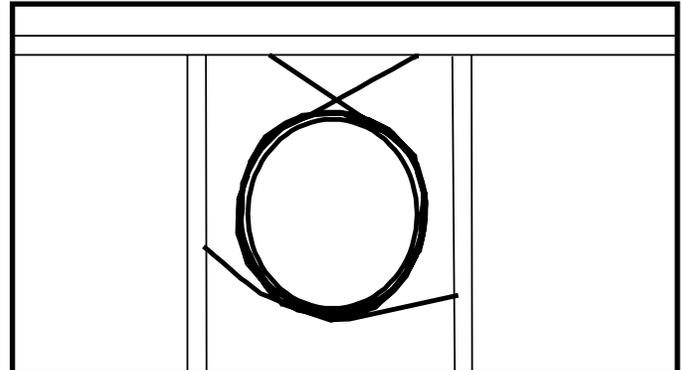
Sujeción de las secciones horizontales del tubo de escape
